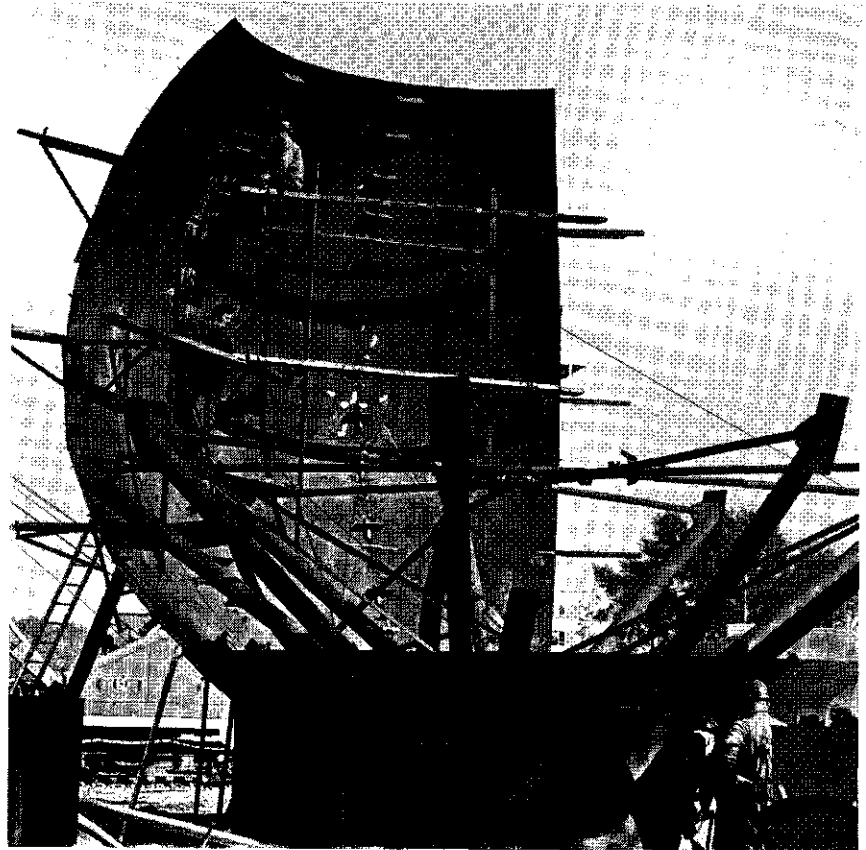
Een van de bolreservoirs in aanbouw met hierin zichtbaar de ophangconstructie van de bol.
